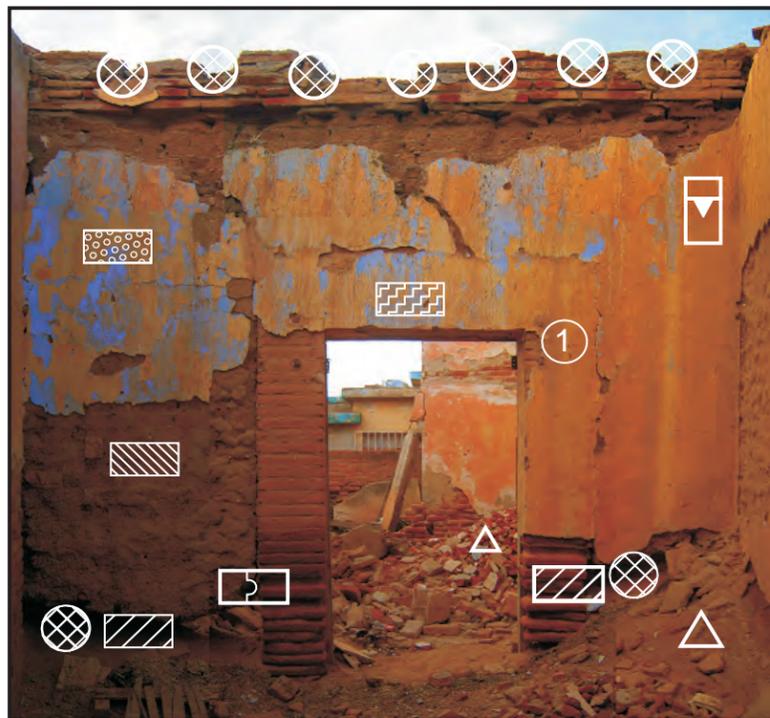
MURO AL NORTE DE LA COCINA, ACCESO A LA RECÁMARA.
